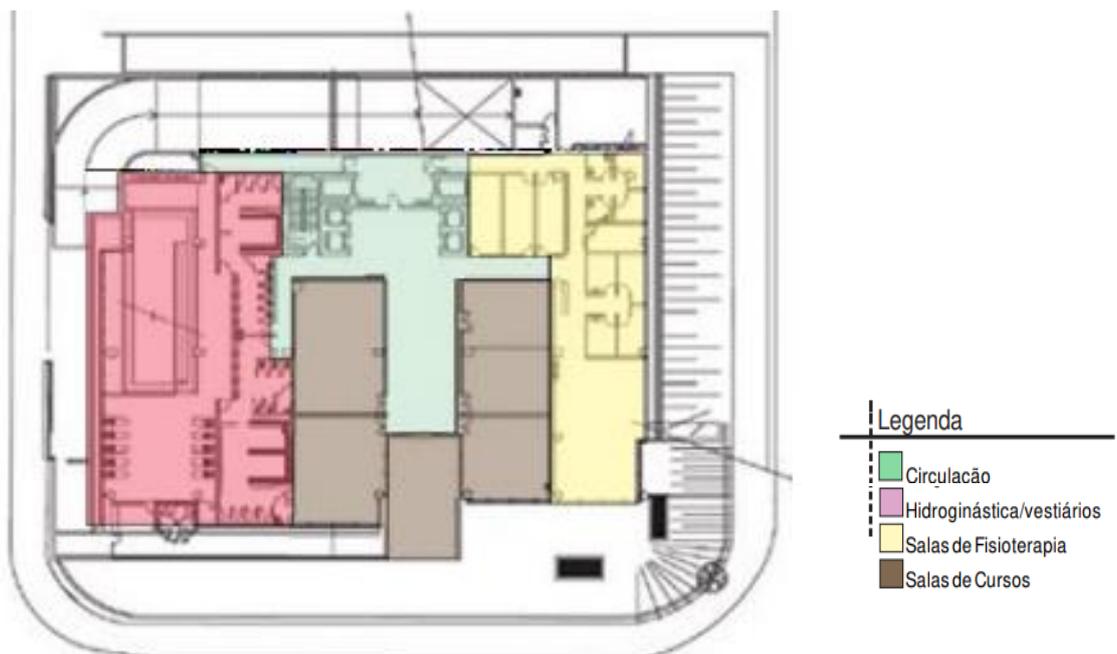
Edifício Hiléa – Setorização Pavimento Tipo.
